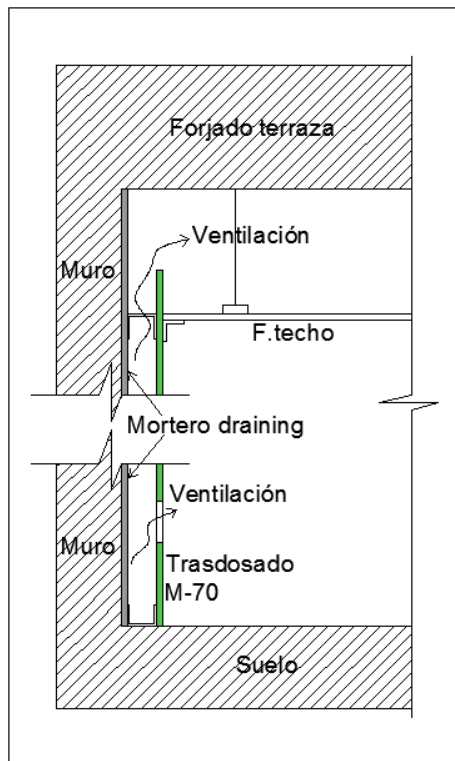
Detalle constructivo de la ventilación de la cámara bufa. 2014. Elaboración propia.
